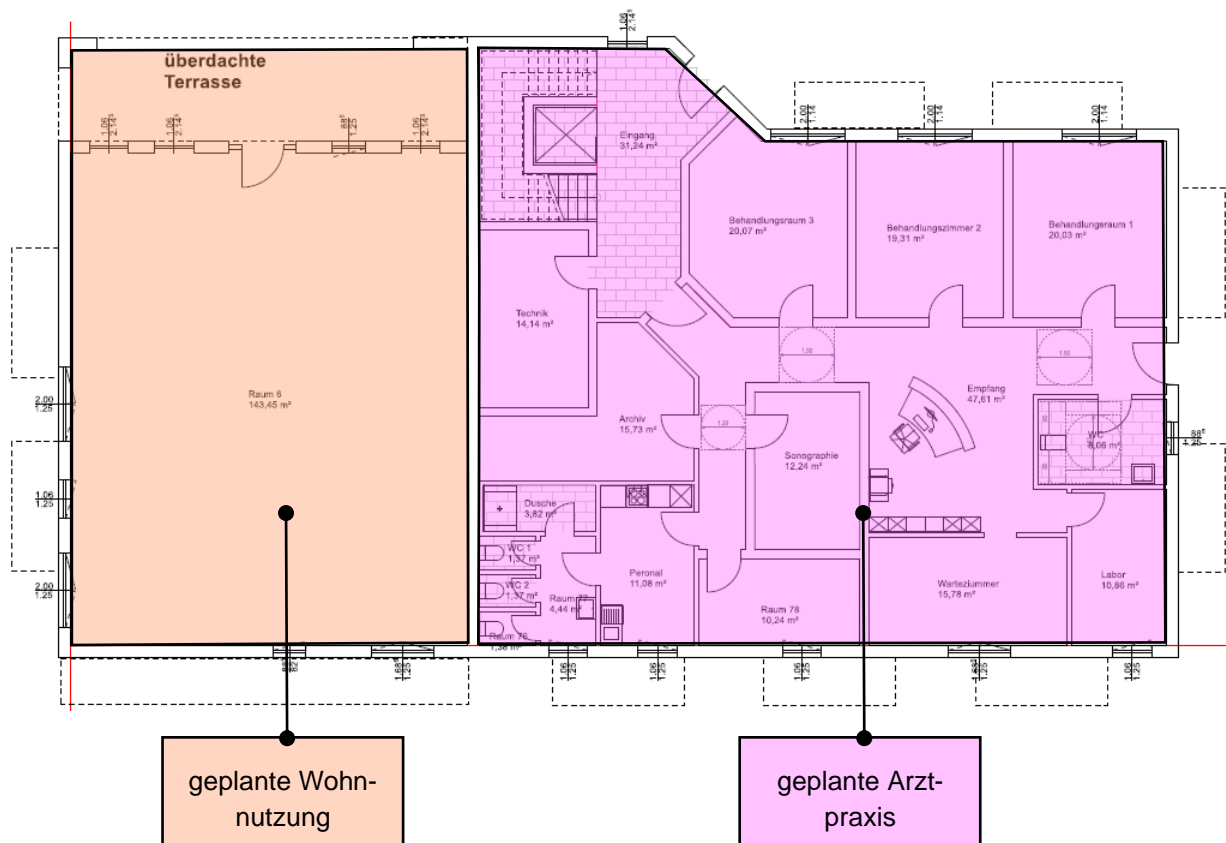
Erdgeschossgrundriss (Vorentwurf) des Vorhabens „Bachgaublick“ mit Darstellung der geplanten Nutzungen, Quelle: Bärenhaus GmbH, Neubrandenburg, 2021; in den darüberliegenden Obergeschossen ist ausschließlich Wohnnutzung geplant
